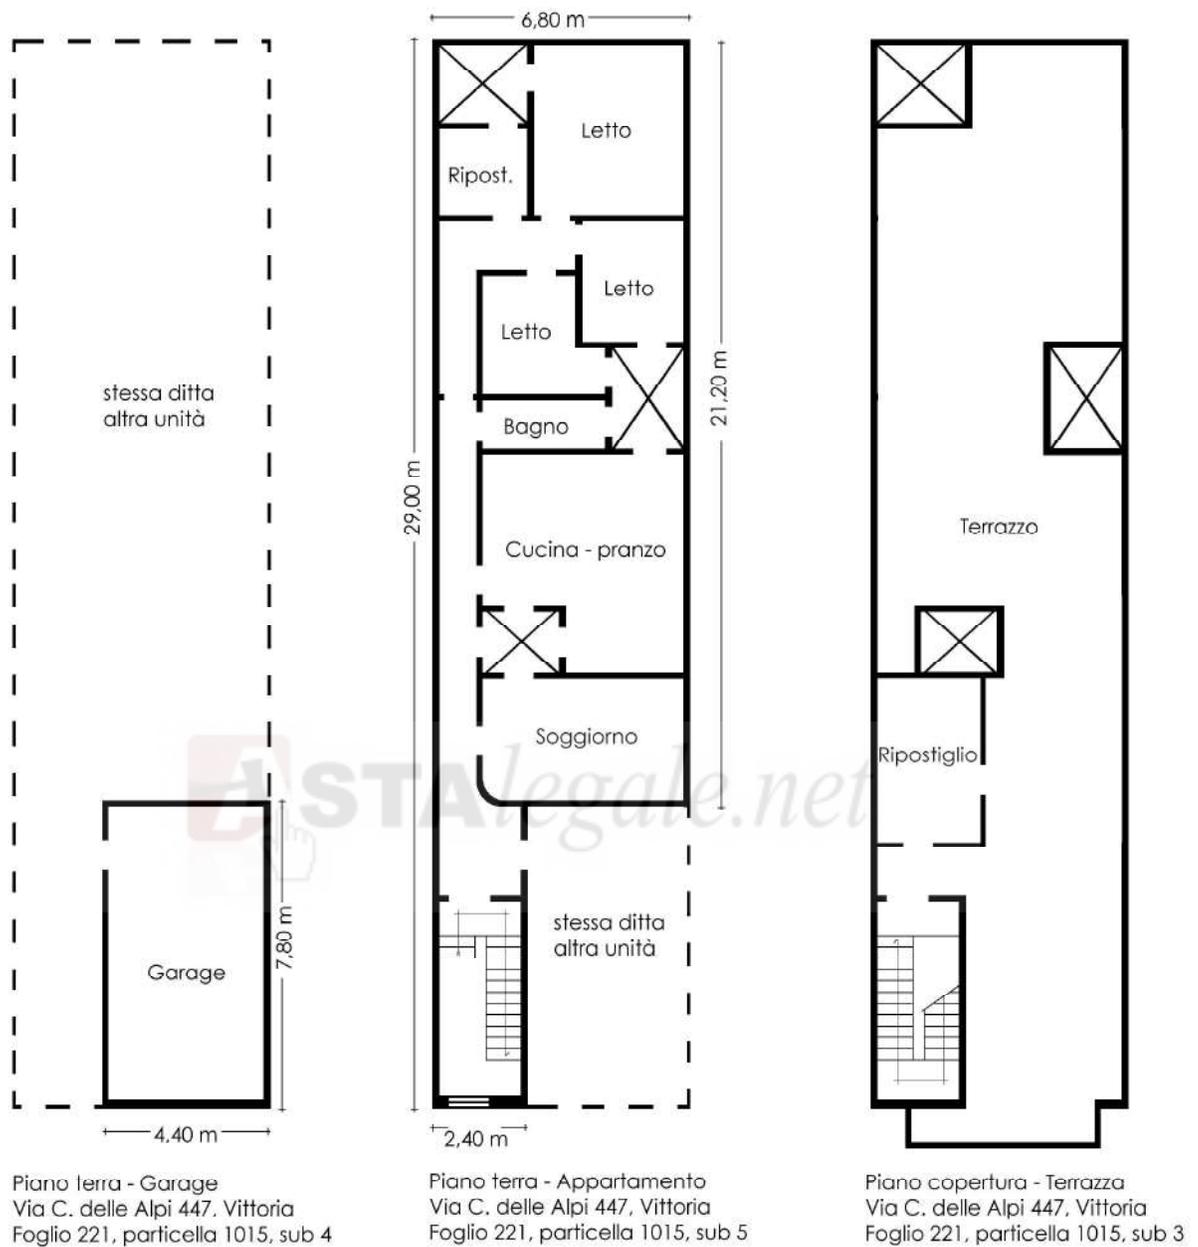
Planimetria rilievo foglio 221 Vittoria particella 1015 sub 3-4-5.
